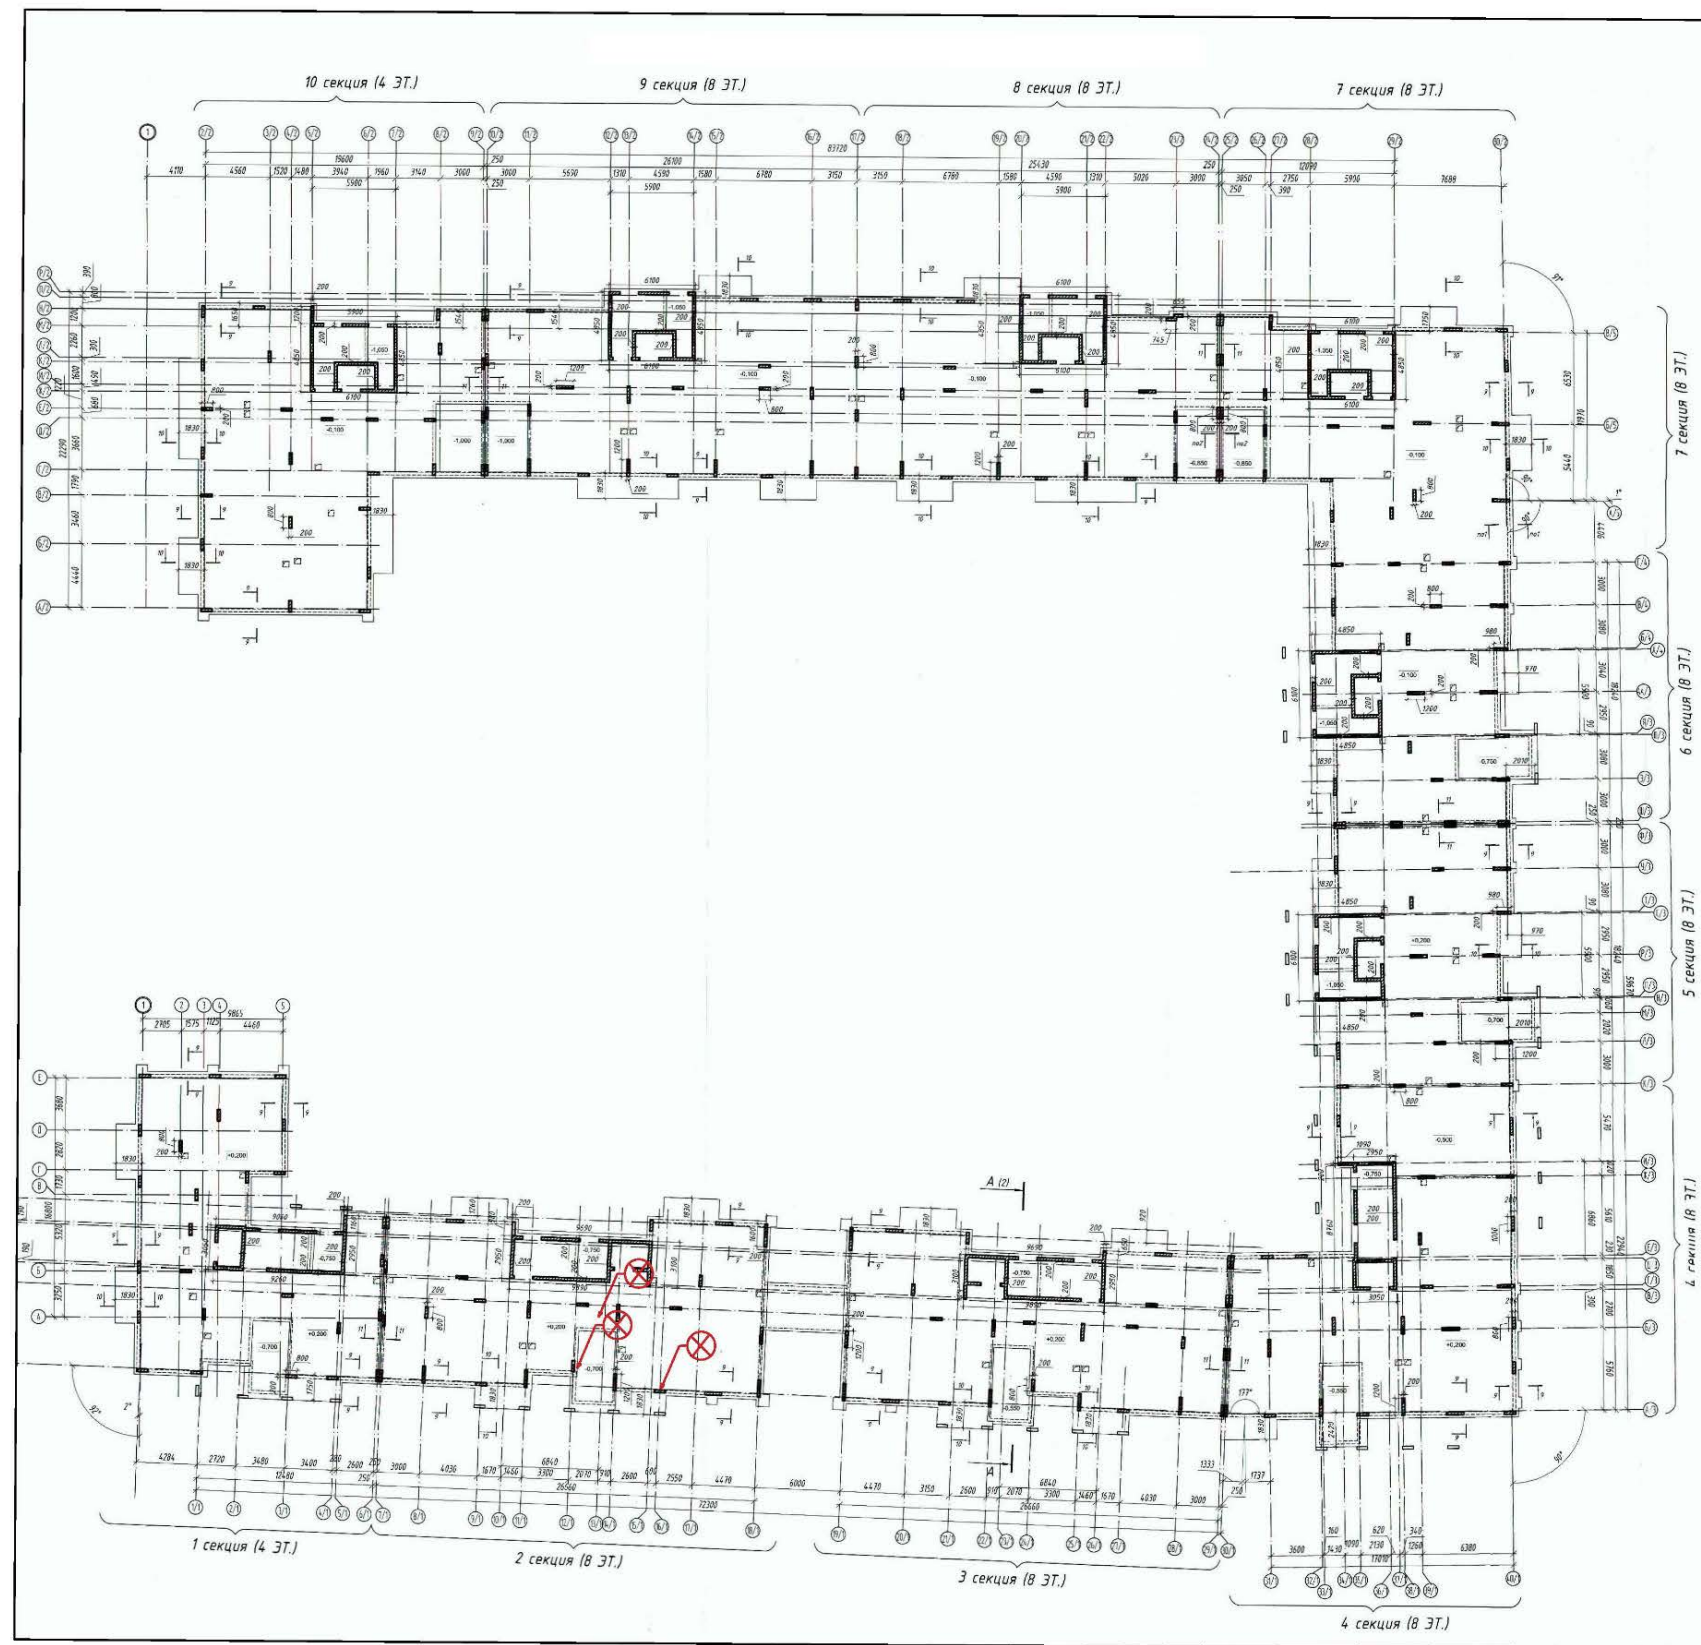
Карта дефектов верхней плоскости плиты перекрытия третьего этажа вертикальных конструкций 4-го этажа
